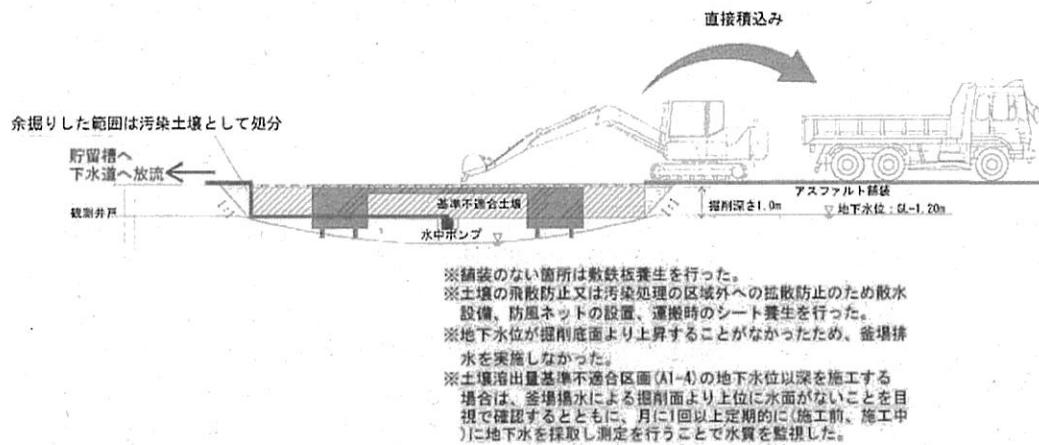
土地の改変の施工方法を明らかにした図面 (A1-4)
